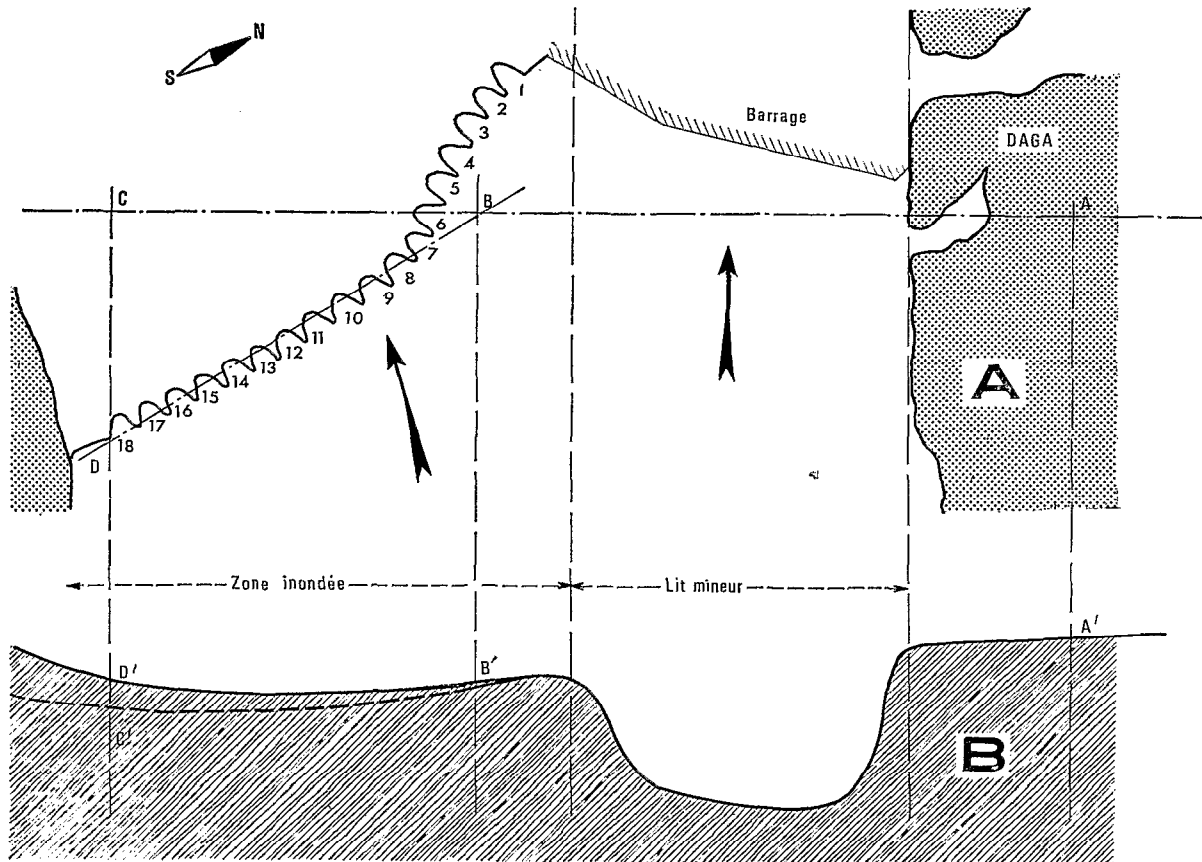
Le barrage de pêche de Daga, plan (A) et coupe (B). Échelles 1/1500^e pour le plan ; 1/100^e pour les hauteurs. (La trame pointillée indique les zones exondées aux hautes eaux 1968-69).
